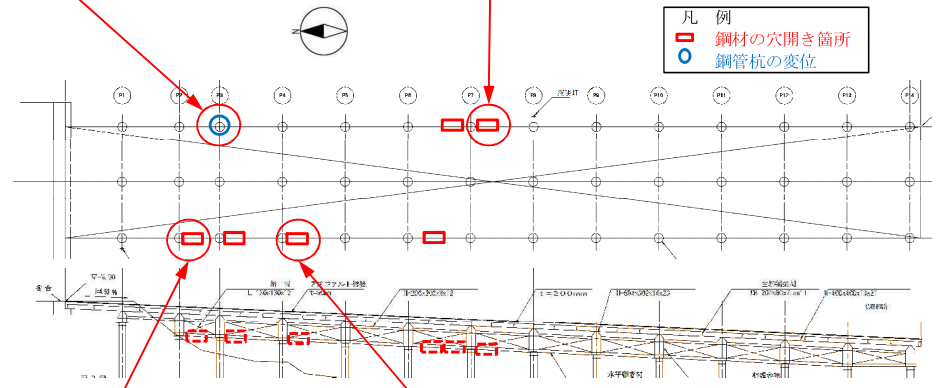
連絡橋 平面・断面図（下部工：海水面より上）
